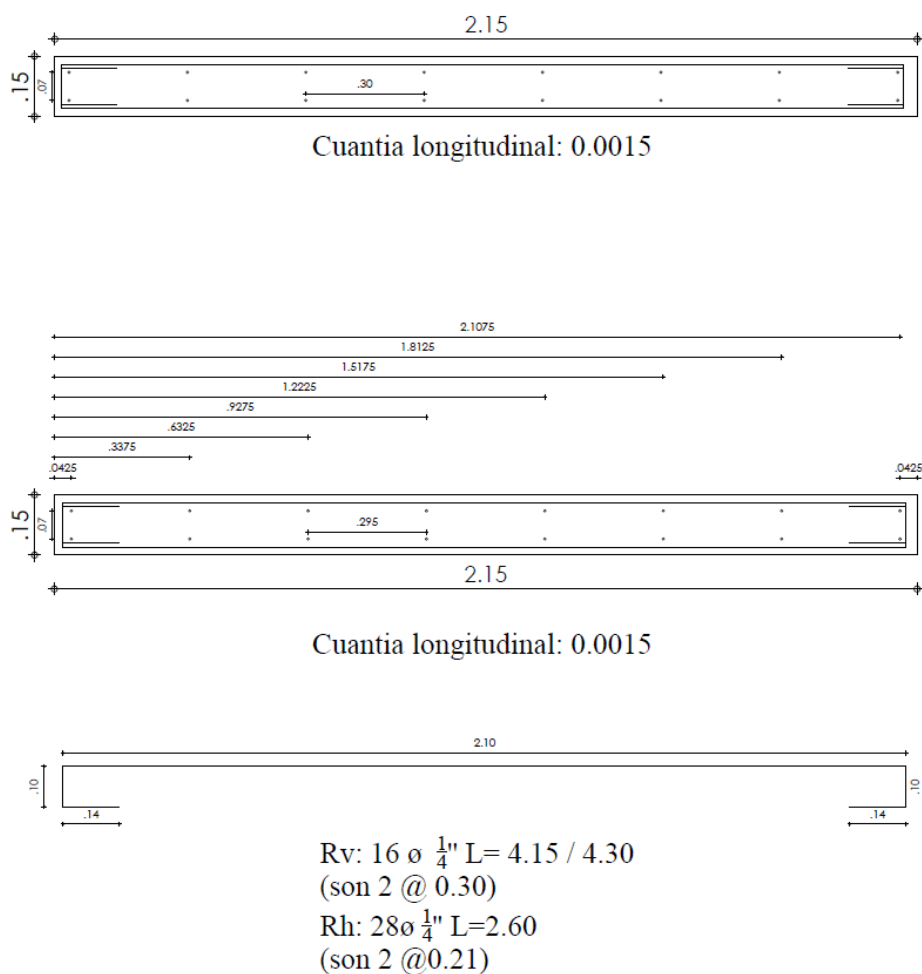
Planta estructural muro de concreto reforzado piso 1.
